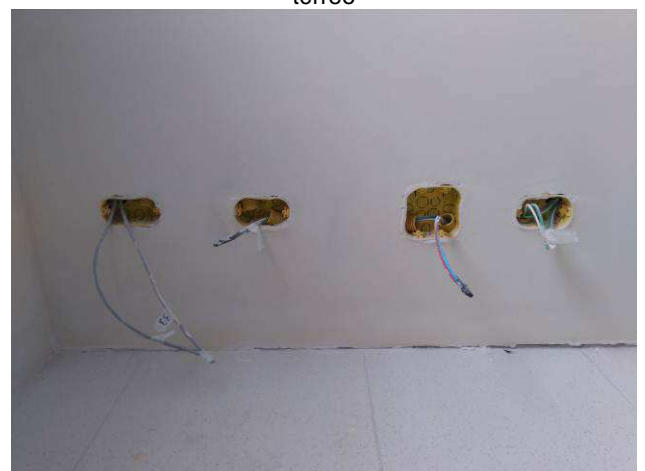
E: infraestrutura elétrica para paredes drywall térreo
